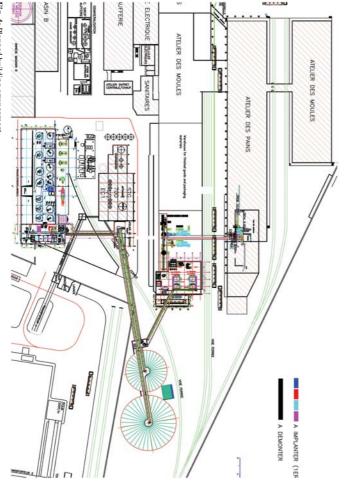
Geplante Gebäudeanordnung Fig. 4: Planned building arrangement
